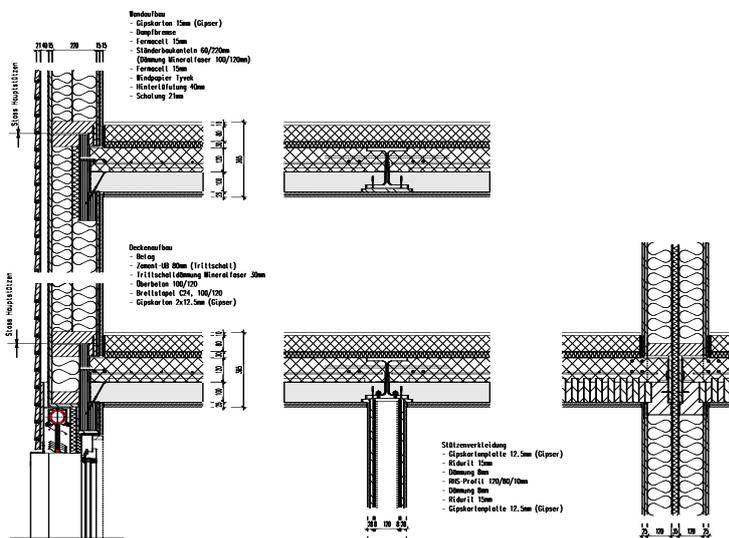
Auf dem Skelett-/Rahmenbau aufgebaute Standarddetails in Kombination mit Stahlträgern als Unterzugsystem und mit Holzbeton-Verbunddecken.
